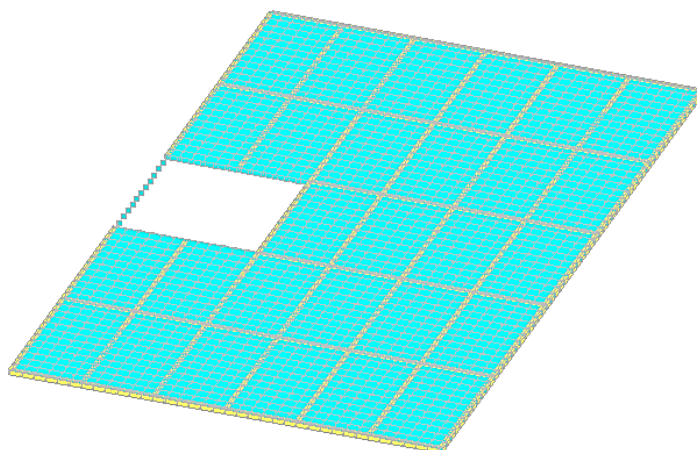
Розрахункова схема монолітного балкового перекриття
